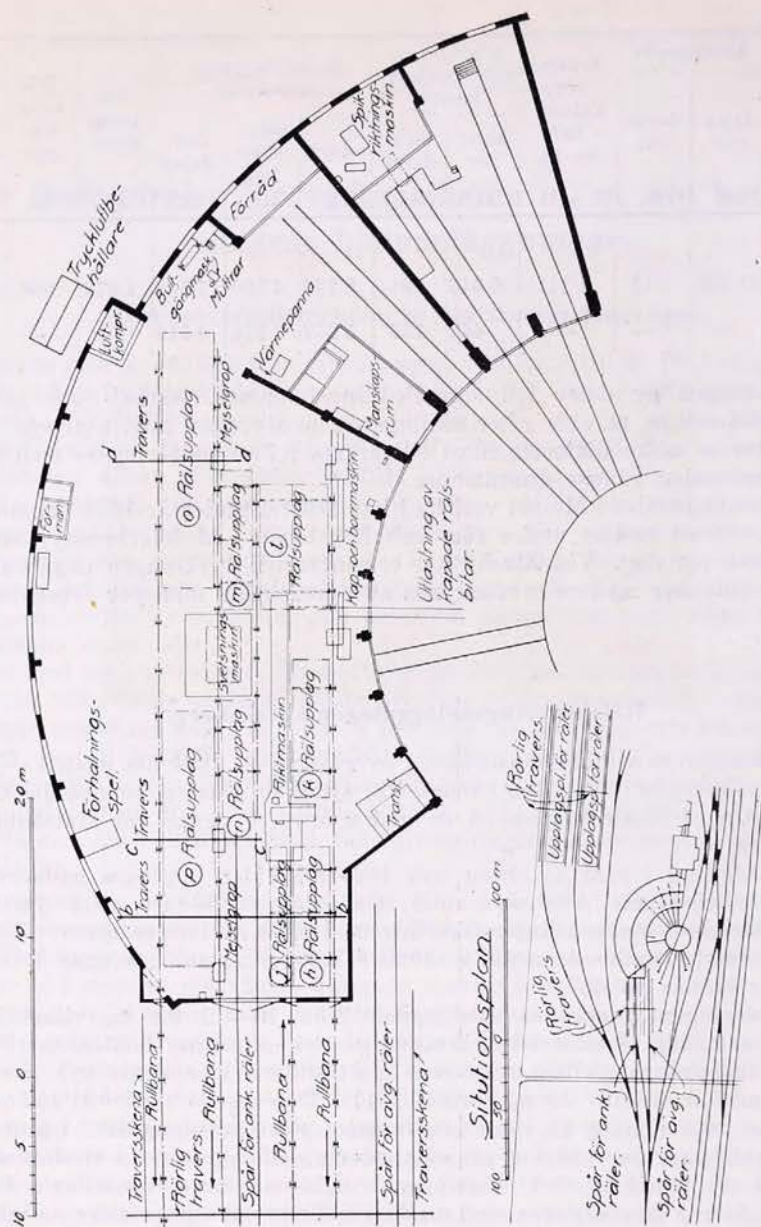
Hallsberg. Plan över rälsjusteringsanläggningen.
